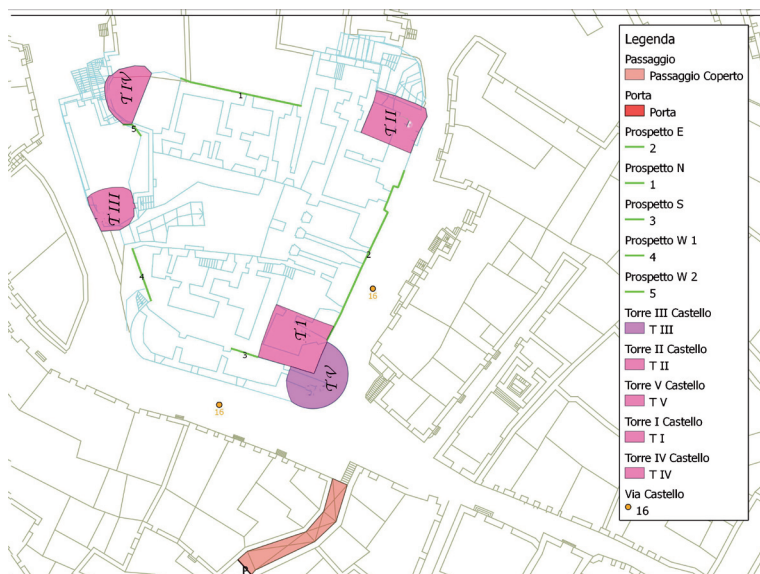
Pianta del castello e posizione rispetto alla porta di accesso al borgo.
